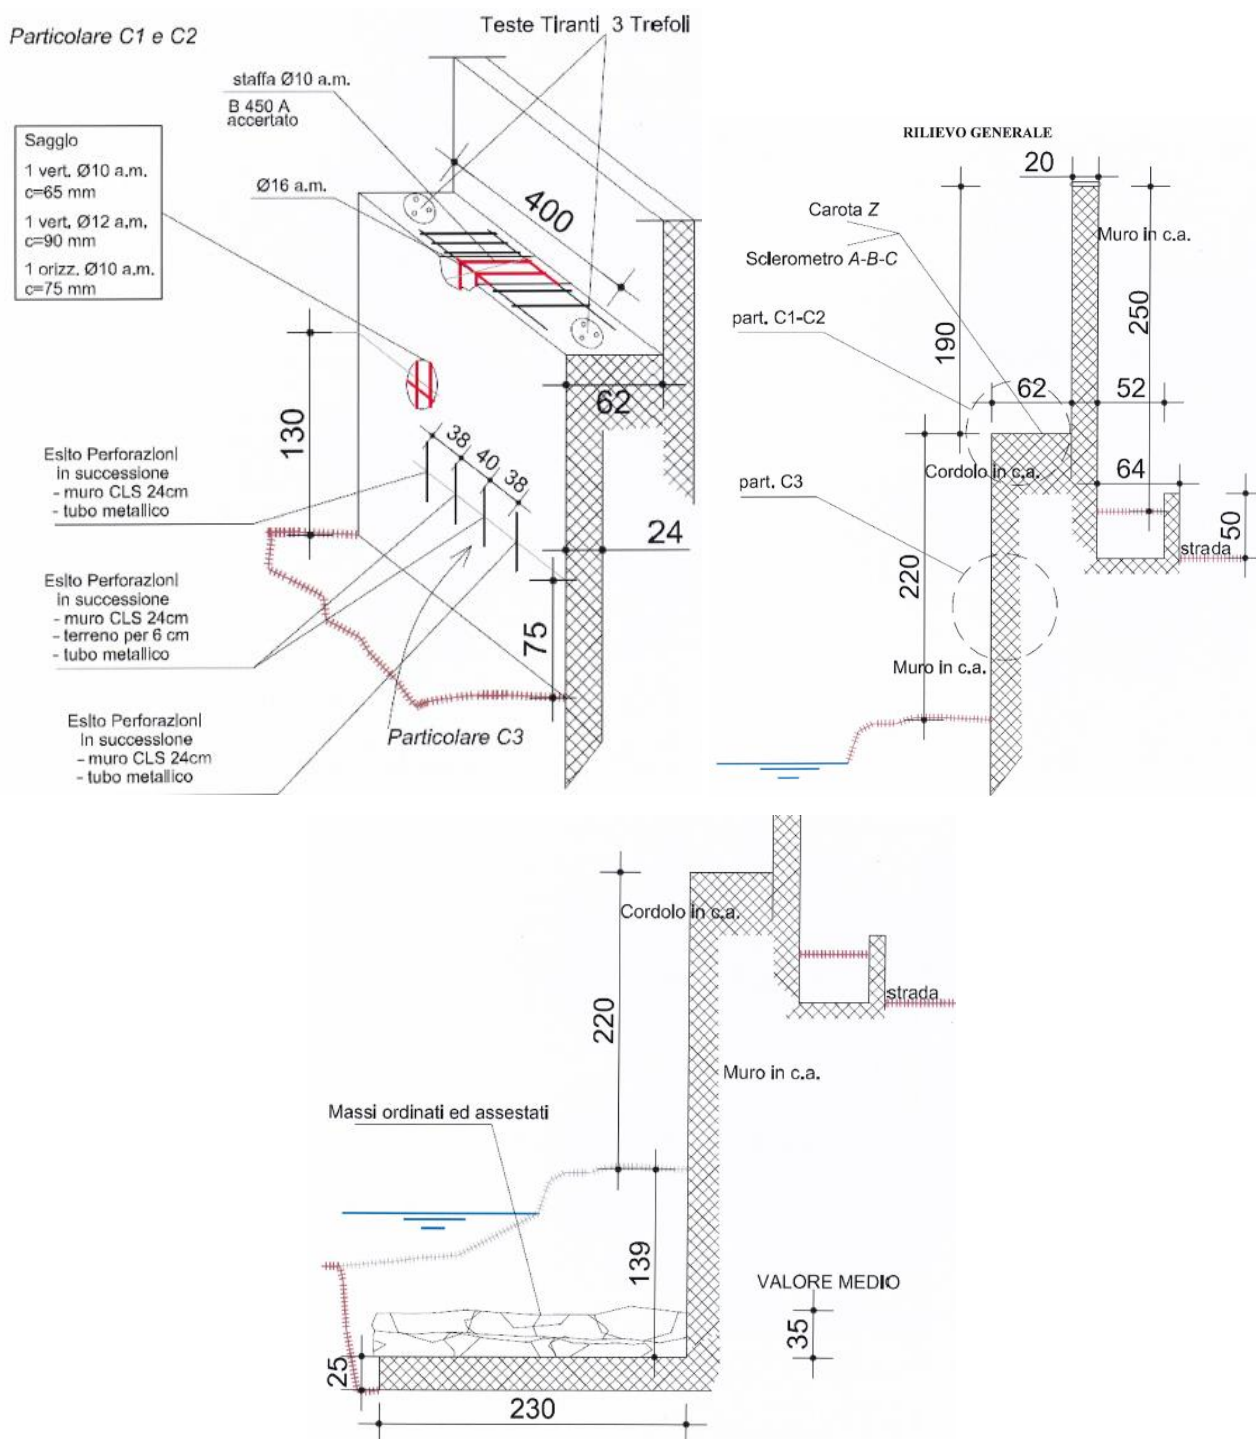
Sezione tipologica strutturale rilevata in sito
